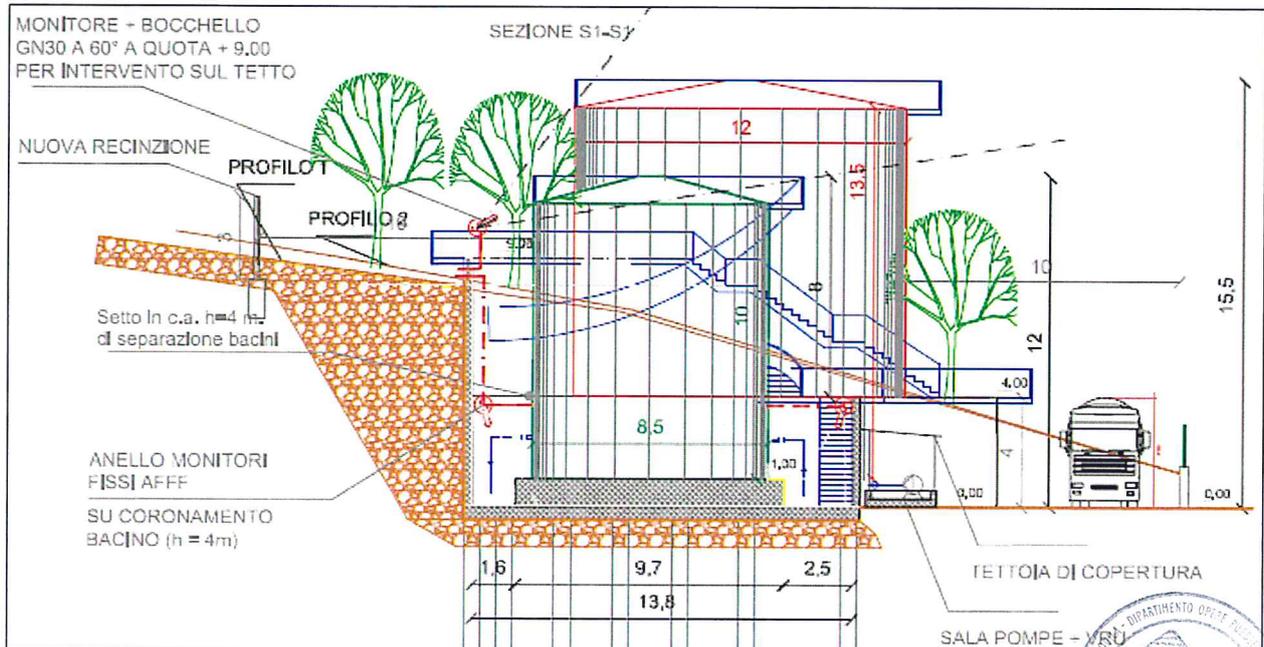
Sezioni di progetto (da Elab. T9 allegato allo SPA)
